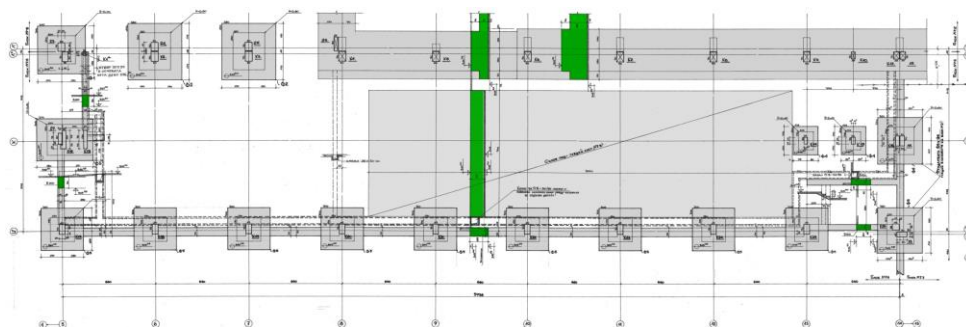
Армировъчен план на плоча – кота 557,74 на блок 5 на УАСГ
